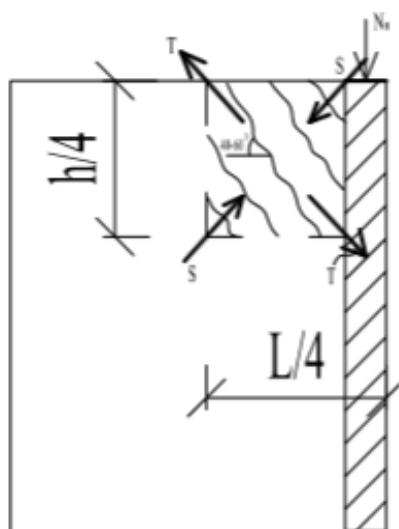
Схема образования трещин и общий вид разрушения стыка разнореформируемых стен при передаче нагрузки на наружную стену
